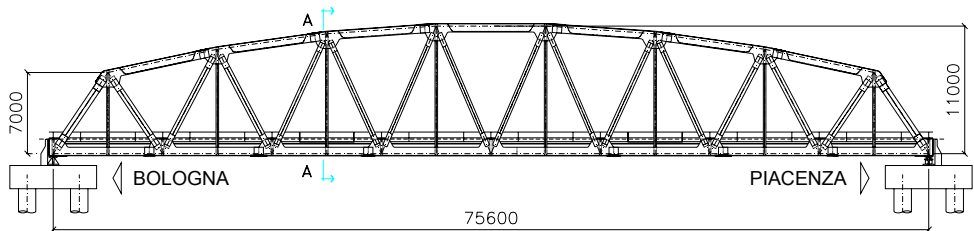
Prospetto laterale del ponte sul Panaro (per gentile concessione di RFI).
